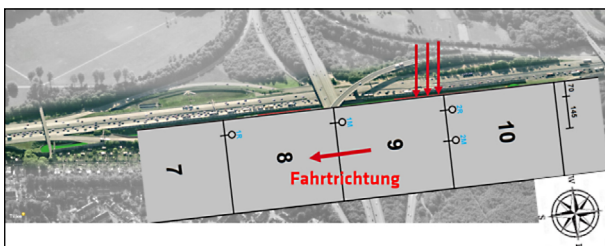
Sensorlage auf dem Waschbetonabschnitt 40
